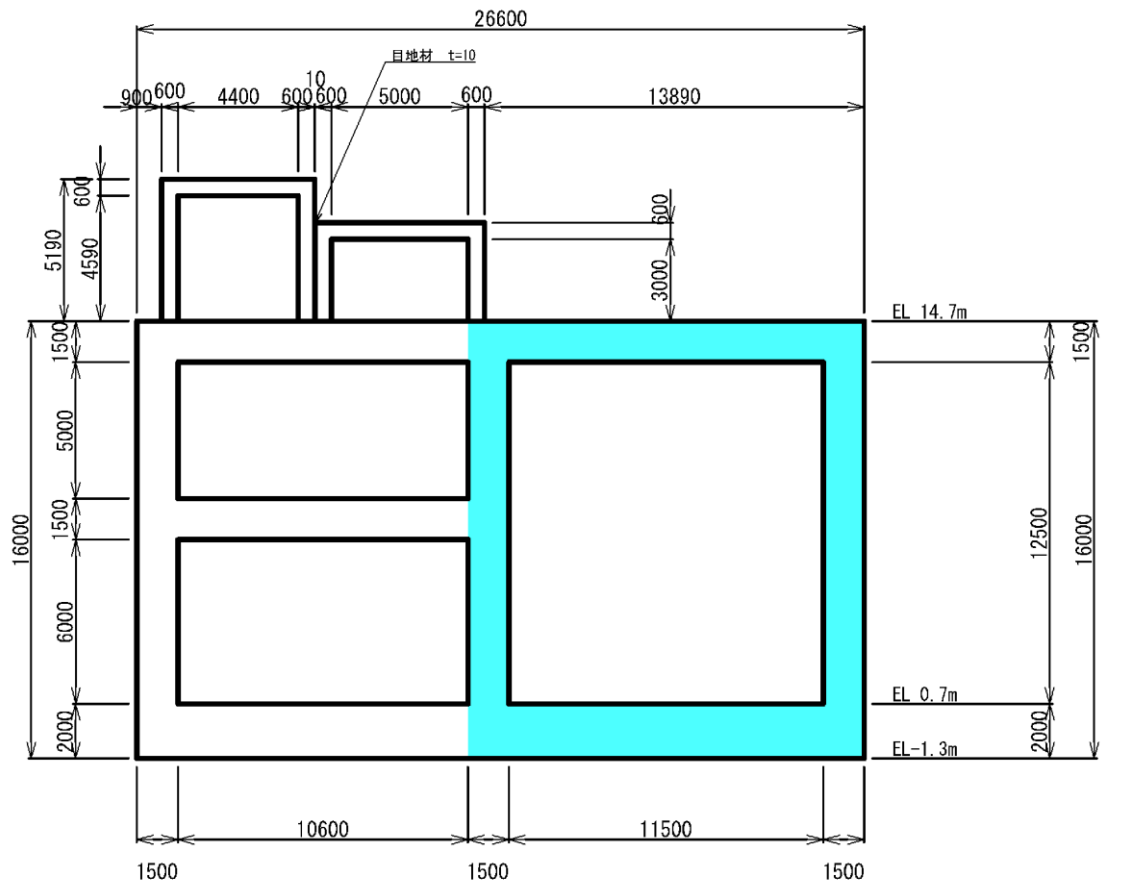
低圧原子炉代替注水ポンプ格納槽 断面図 (B-B 断面)
